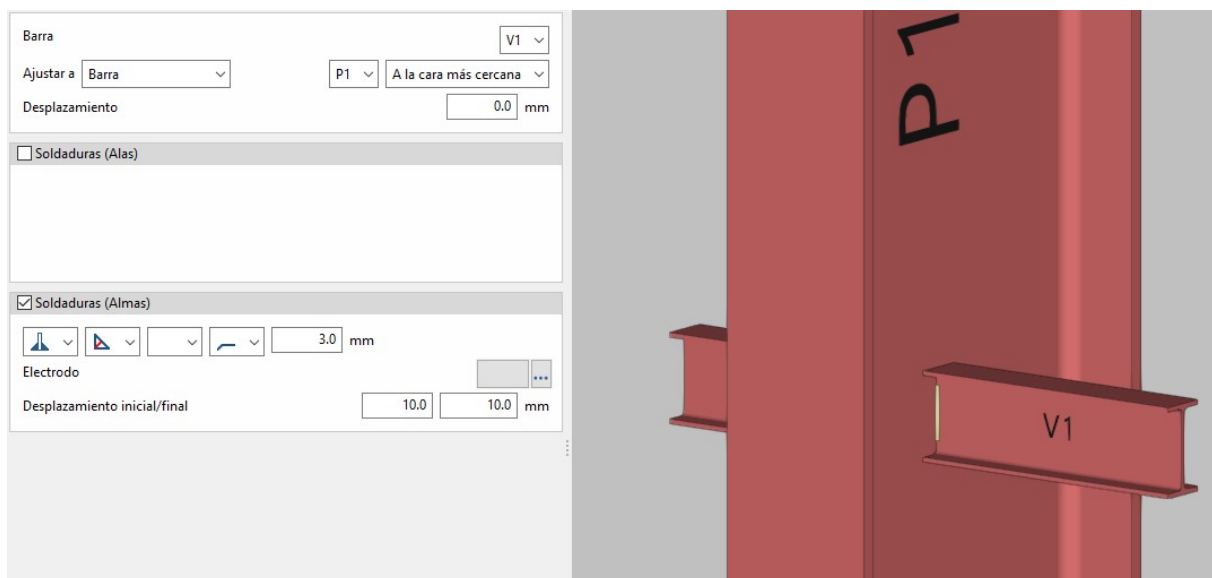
“Ajuste de perfil V1 a pilar P1 con soldadura de alma. CYPE Connect. Fuente: Propia.”
